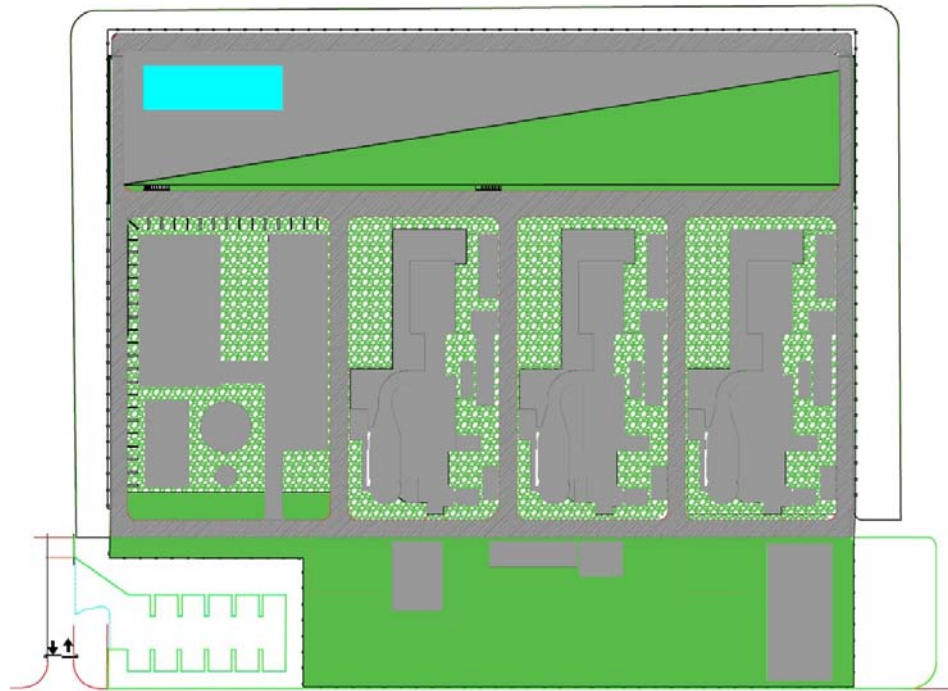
Rappresentazione delle aree permeabili e impermeabili
